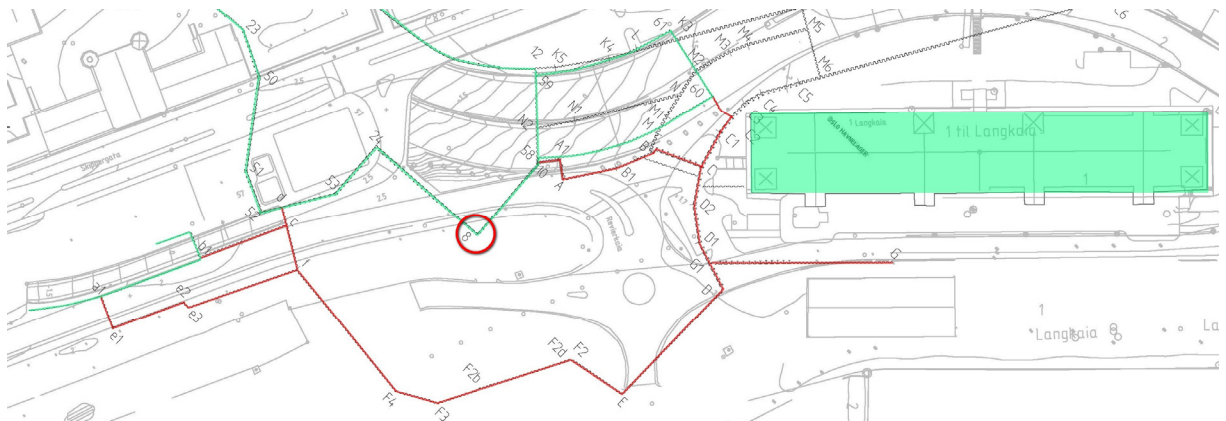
Spunt for Hovedgrop (rød) og spunt fra Festningstunnelen (grønn)
